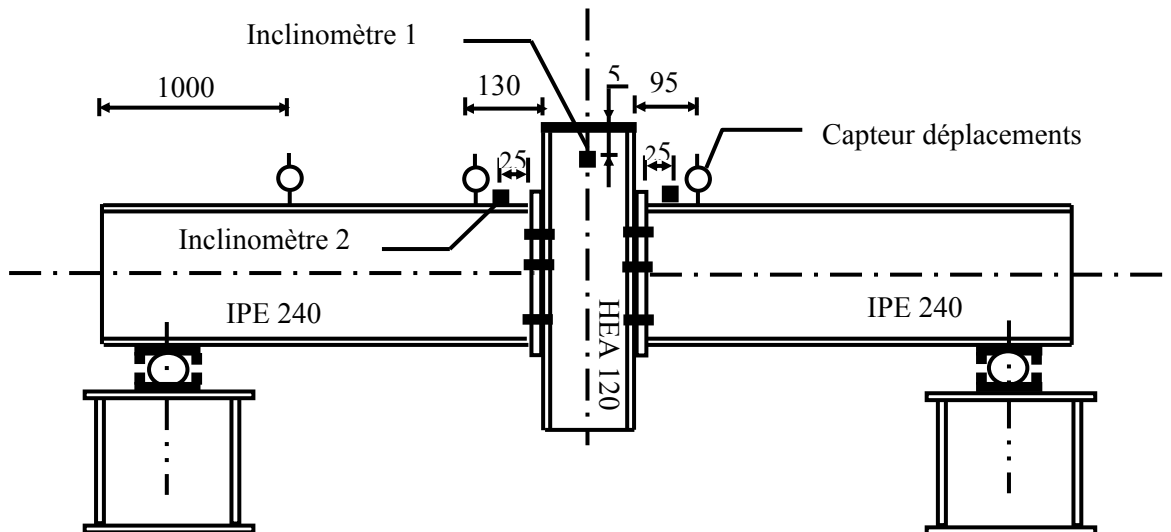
Dispositif de mesure de l'assemblage FS1
